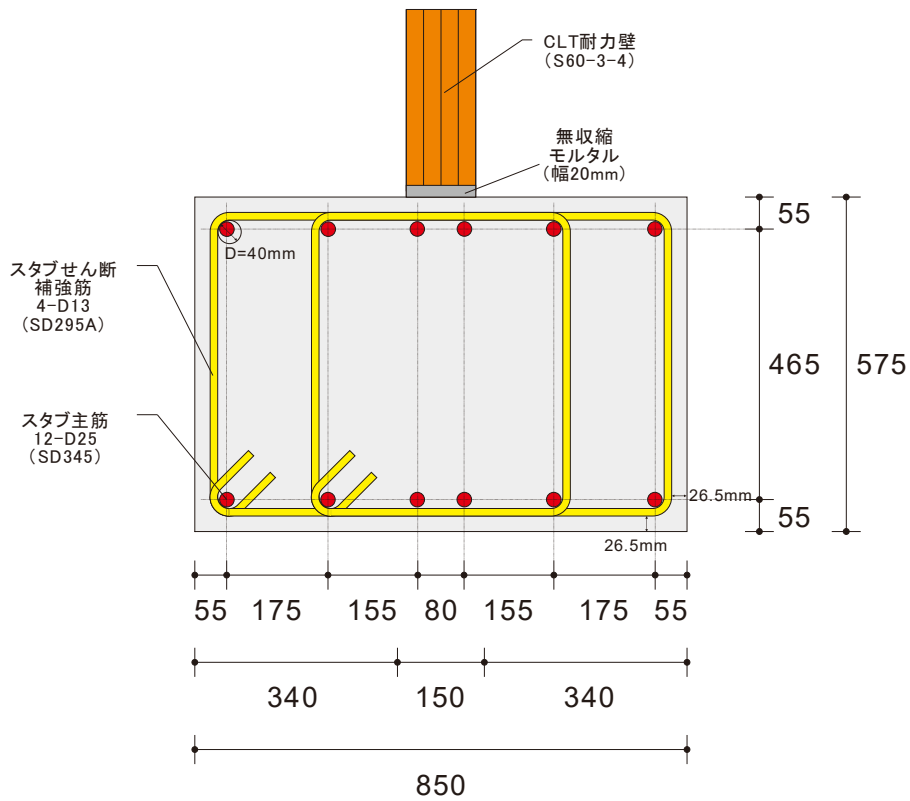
試験体 WB の CLT 耐力壁取り付け後のスタブの断面図
